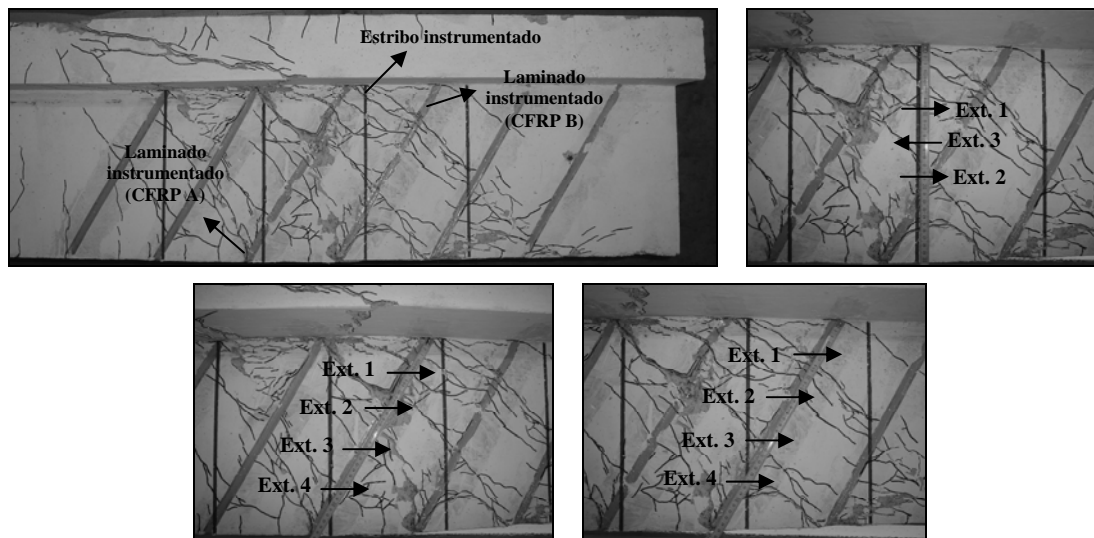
Localização dos extensómetros no laminado e estribo instrumentados da viga 4S-6LI60-C.
